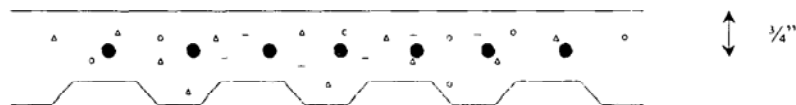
Cubierta mínima de concreto sobre refuerzo negativo
